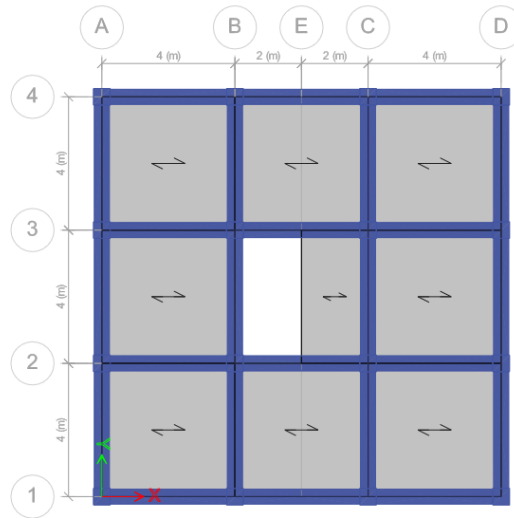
Planta típica de las estructuras prototipo de pórticos.
